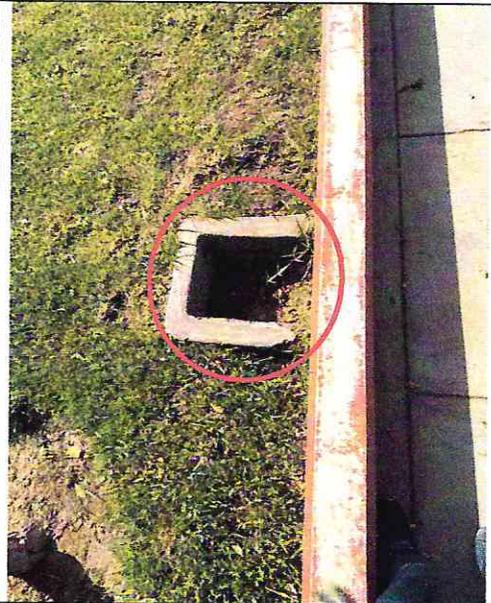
Caja de concreto para agua en mal estado y sin tapa, y jardineras despintadas.
